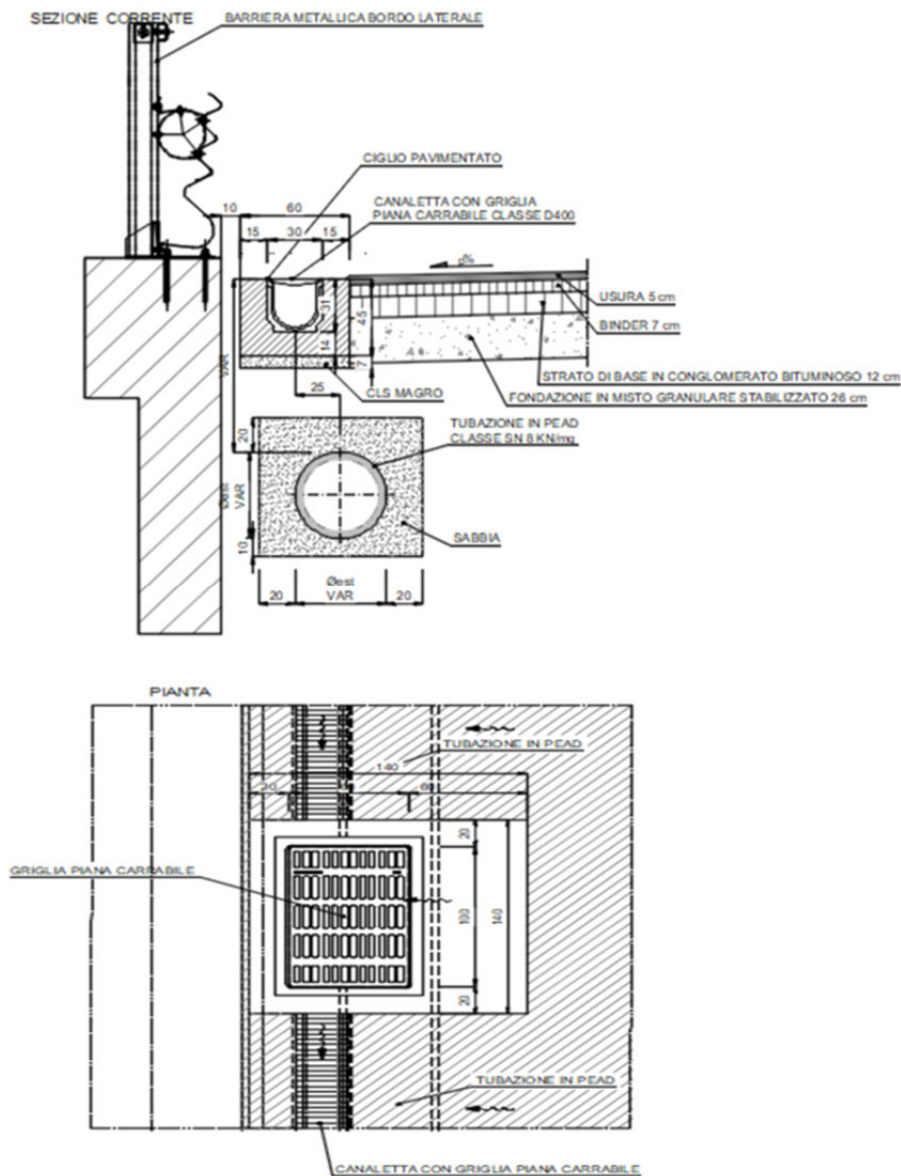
Raccolta delle acque di piattaforma in rilevato con muro.
